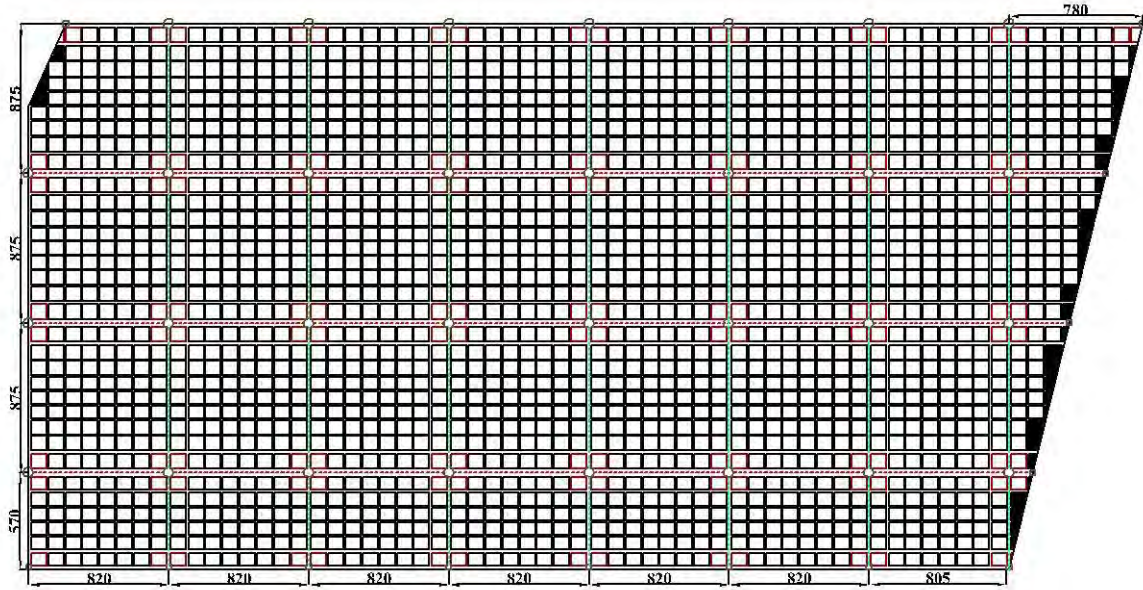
Vista en planta de estructura a estudiar (cotas en cm).
